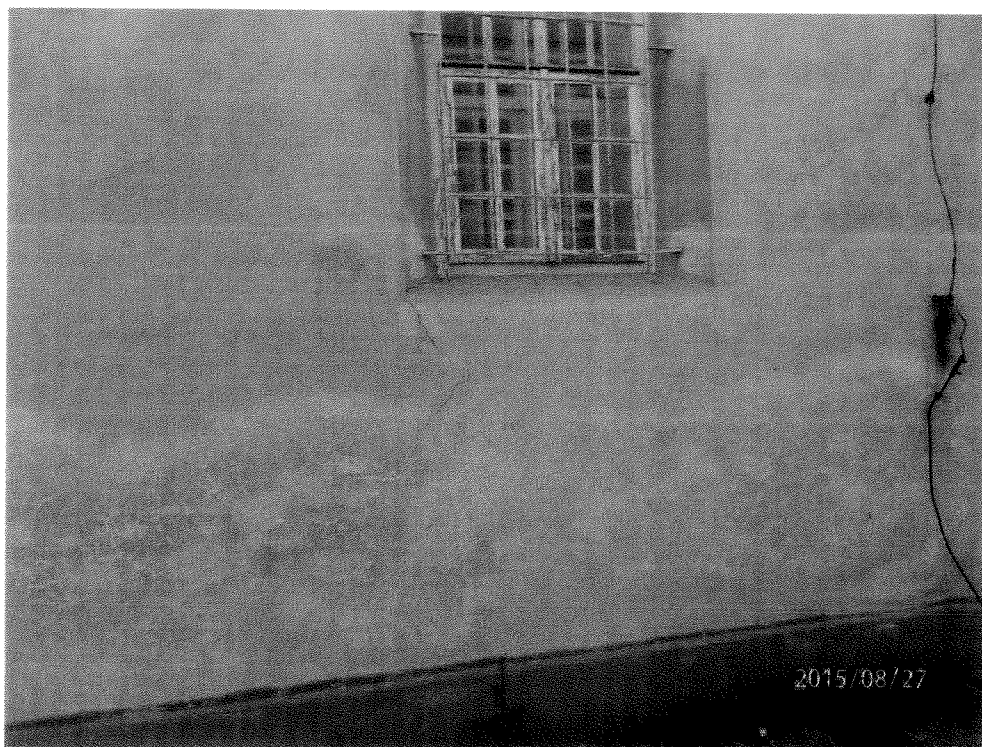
Fragment elewacji północnej. Rysy ukośne w narożach okien. Zawilgocenia muru.
